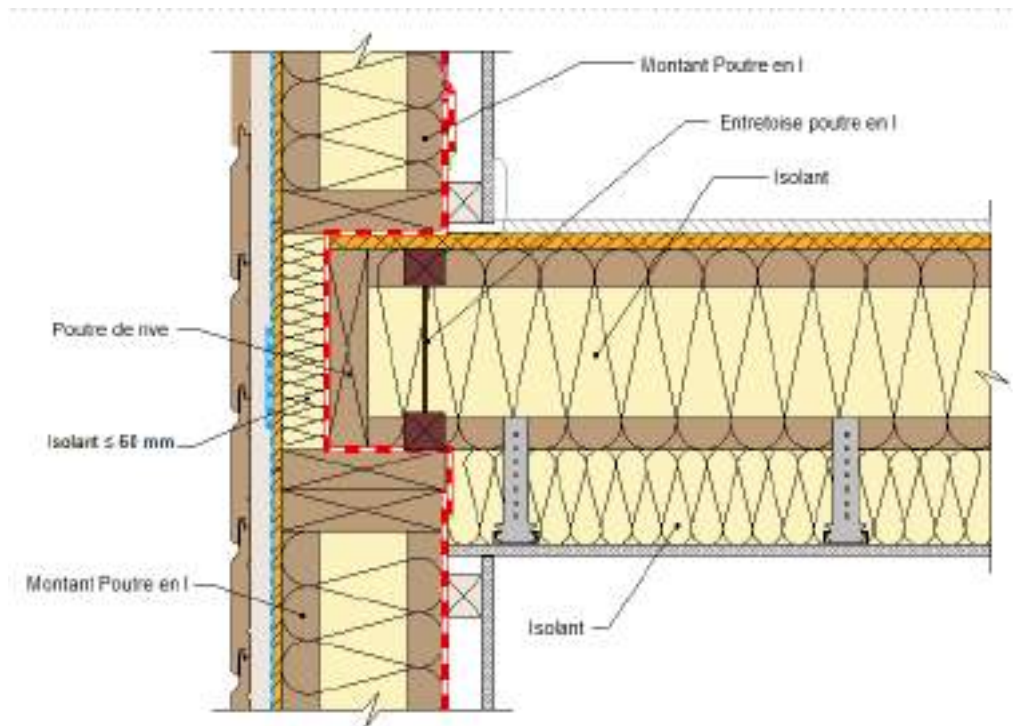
Liaison mur extérieur / plancher intermédiaire en technique plateforme
